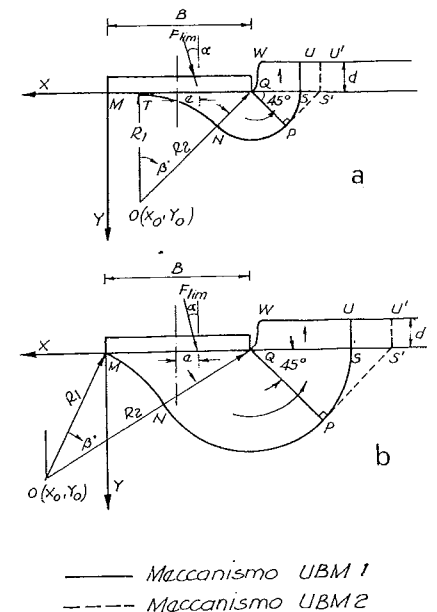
Meccanismi di collasso: a) con distacco fra terreno e fondazione; b) senza distacco.
